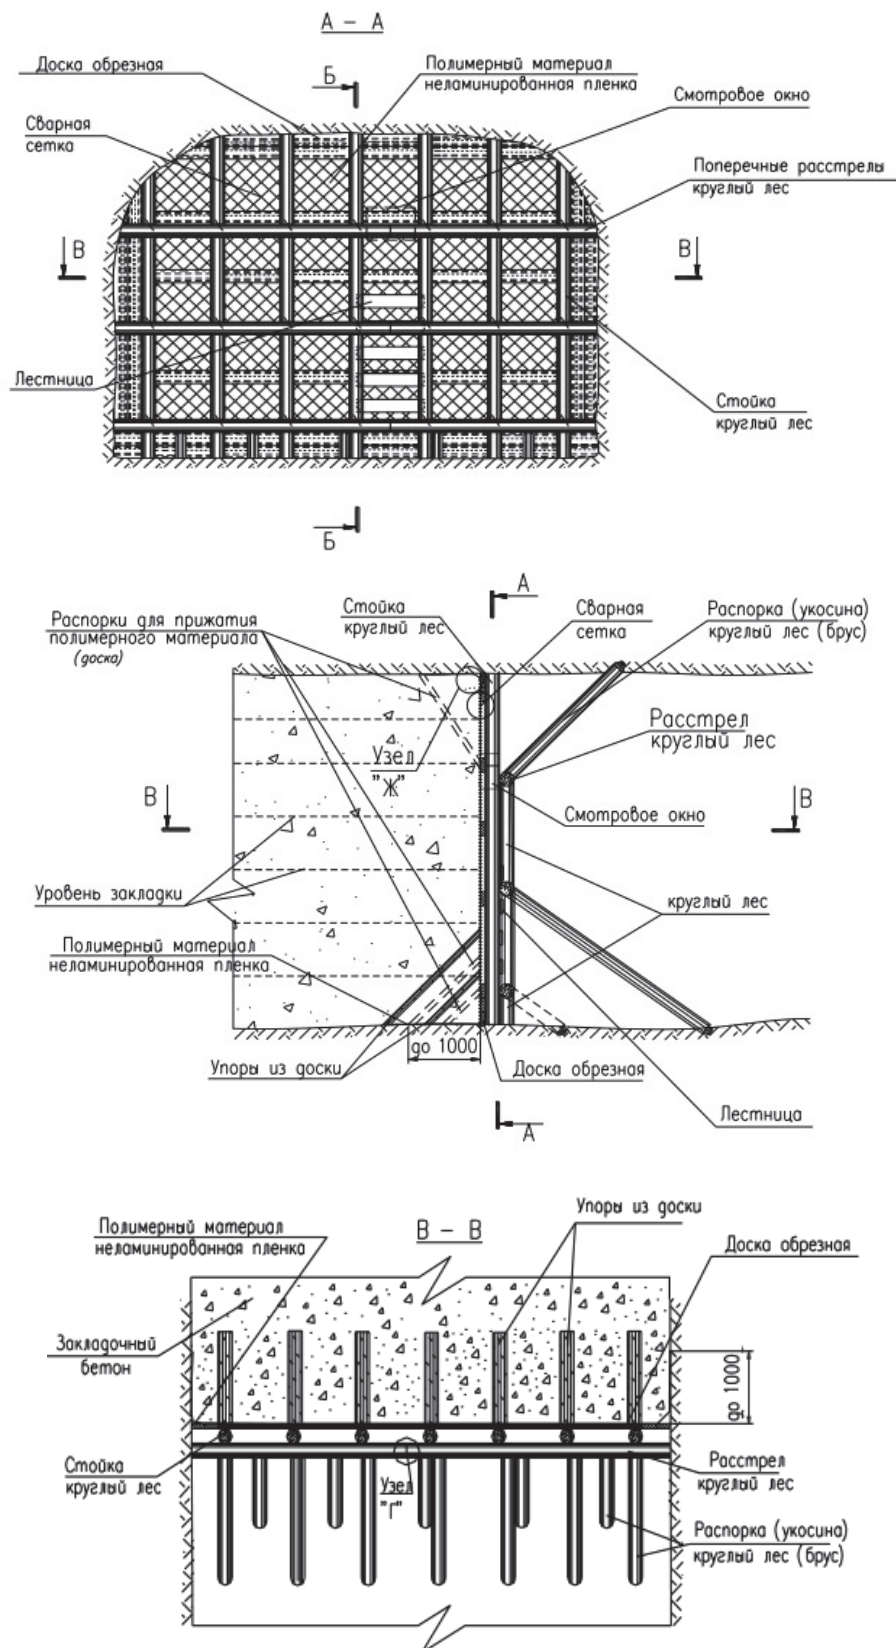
Конструкция глухой ЗП с элементами из полимерных материалов (неламинированной пленки) и сварной металлической решетки (вариант без подсыпки перемычки горной массой)
